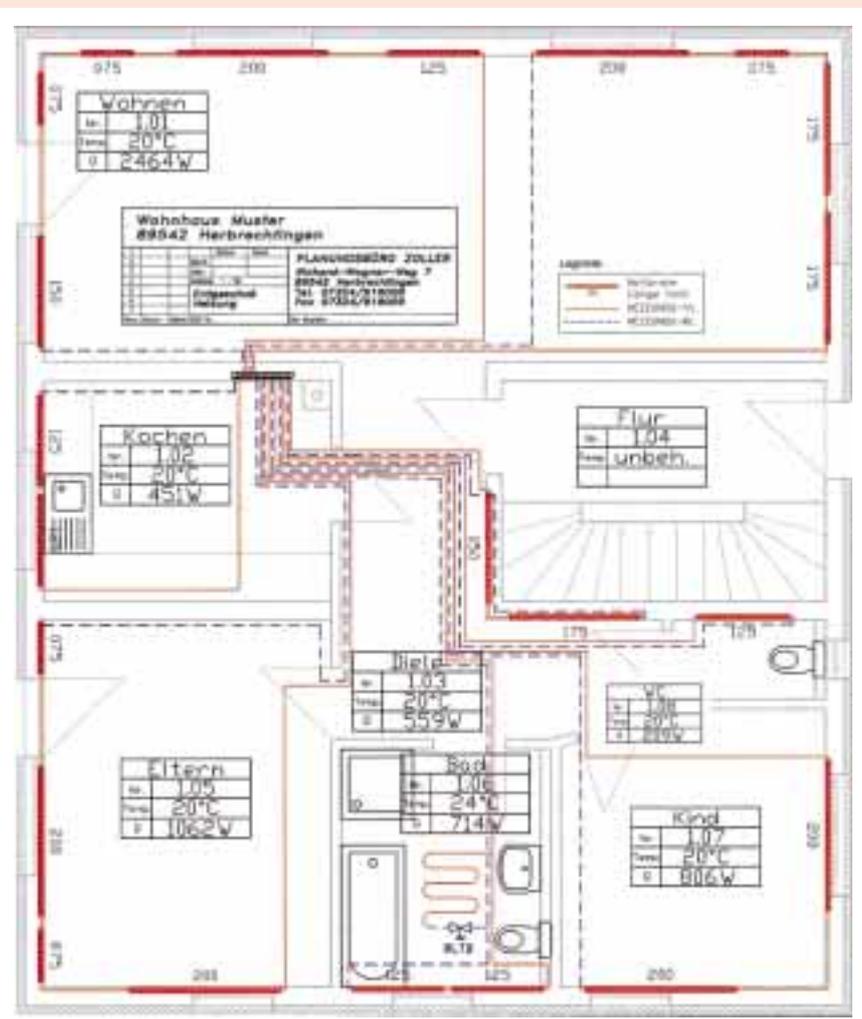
Grundrisszeichnung mit Projekt- und Auslegungsdaten (Kalksand-Luftkanalsandstein mit Außendämmung; System im Fensterbereich geöffnet)
